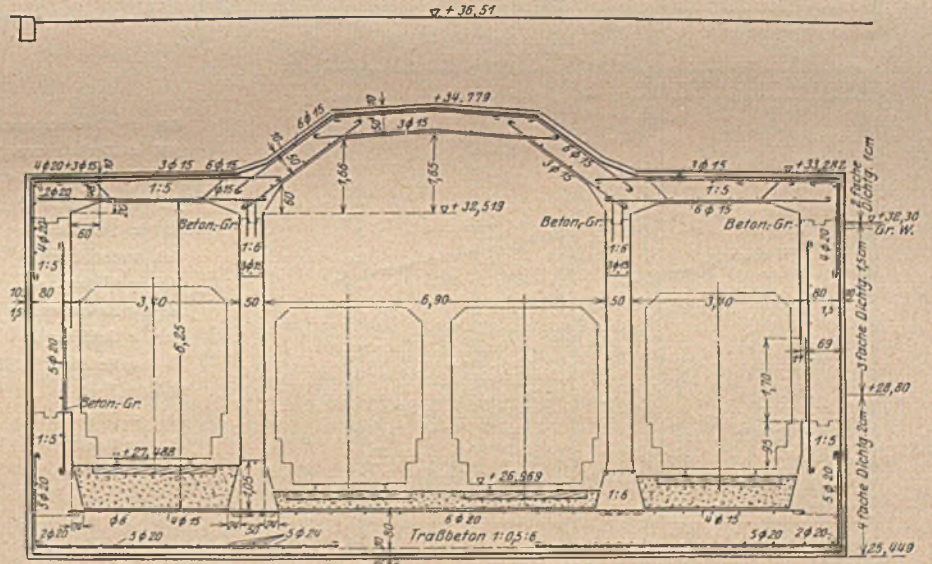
Rahmenquerschnitt mit zwei Mittelstützen (östliche Übergangsstrecke).
